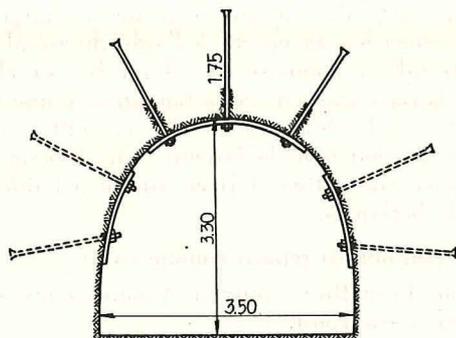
Section du bouveau avec soutènement en bêles T-H boulonnées sans montant.
